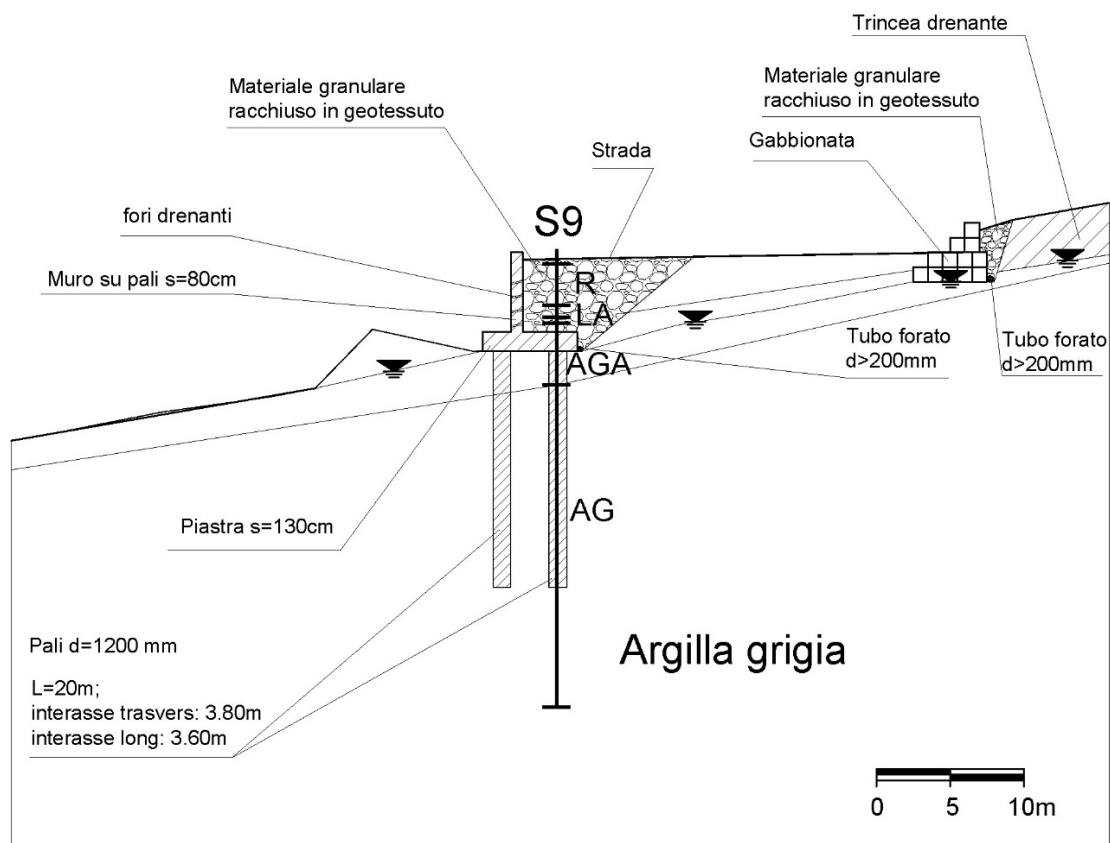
Dissesto al km 9+000. Sezione con schema degli interventi di consolidamento. Particolare in corrispondenza della strada.
